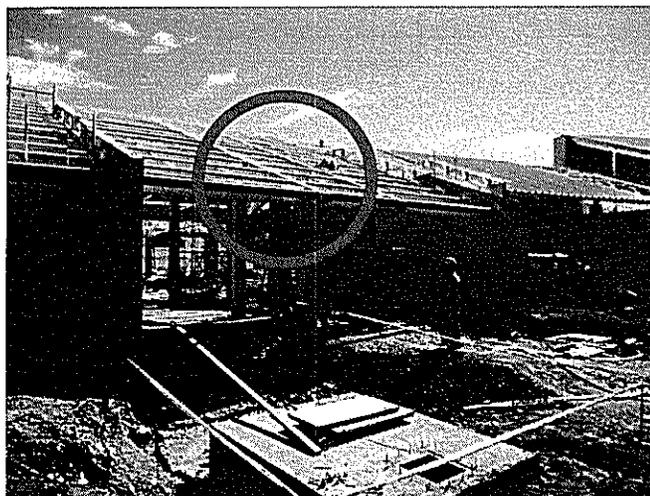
Viga en eje B del sector gimnasio desaplomada y desnivelada.
